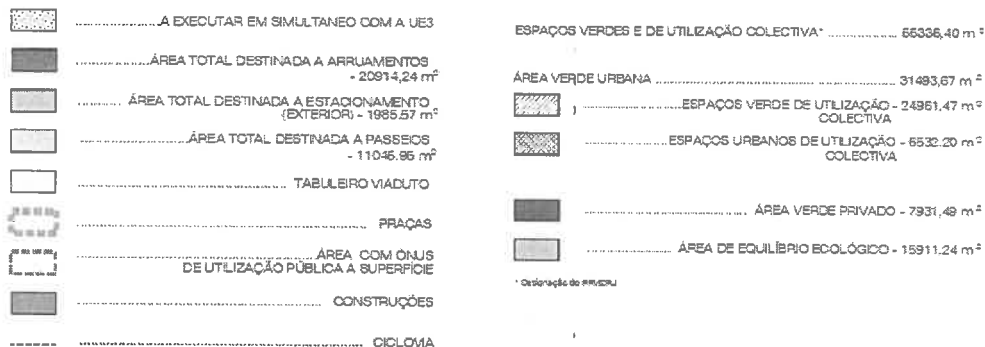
Extrato da Planta de Espaços Verdes e de Utilização Coletiva e Infraestruturas Viárias (Des. A-12A, Ficheiro ARQ.86.dwf)
